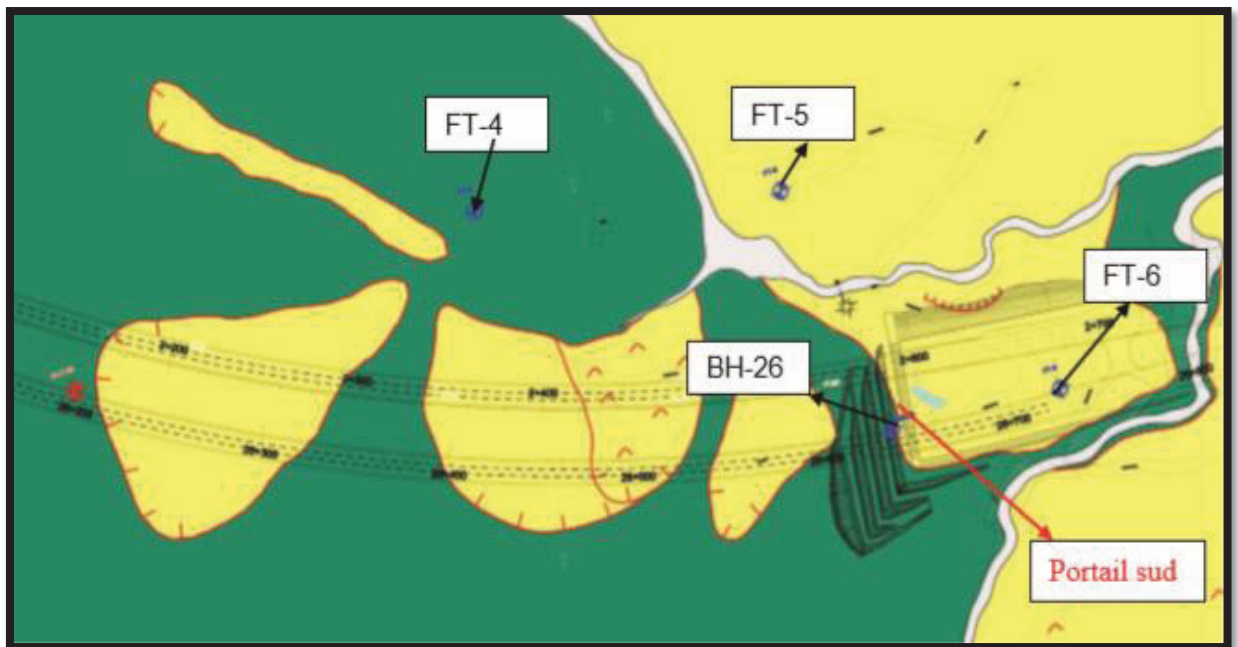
Plan d'installation du sondage situé sur la section du Portail Sud
